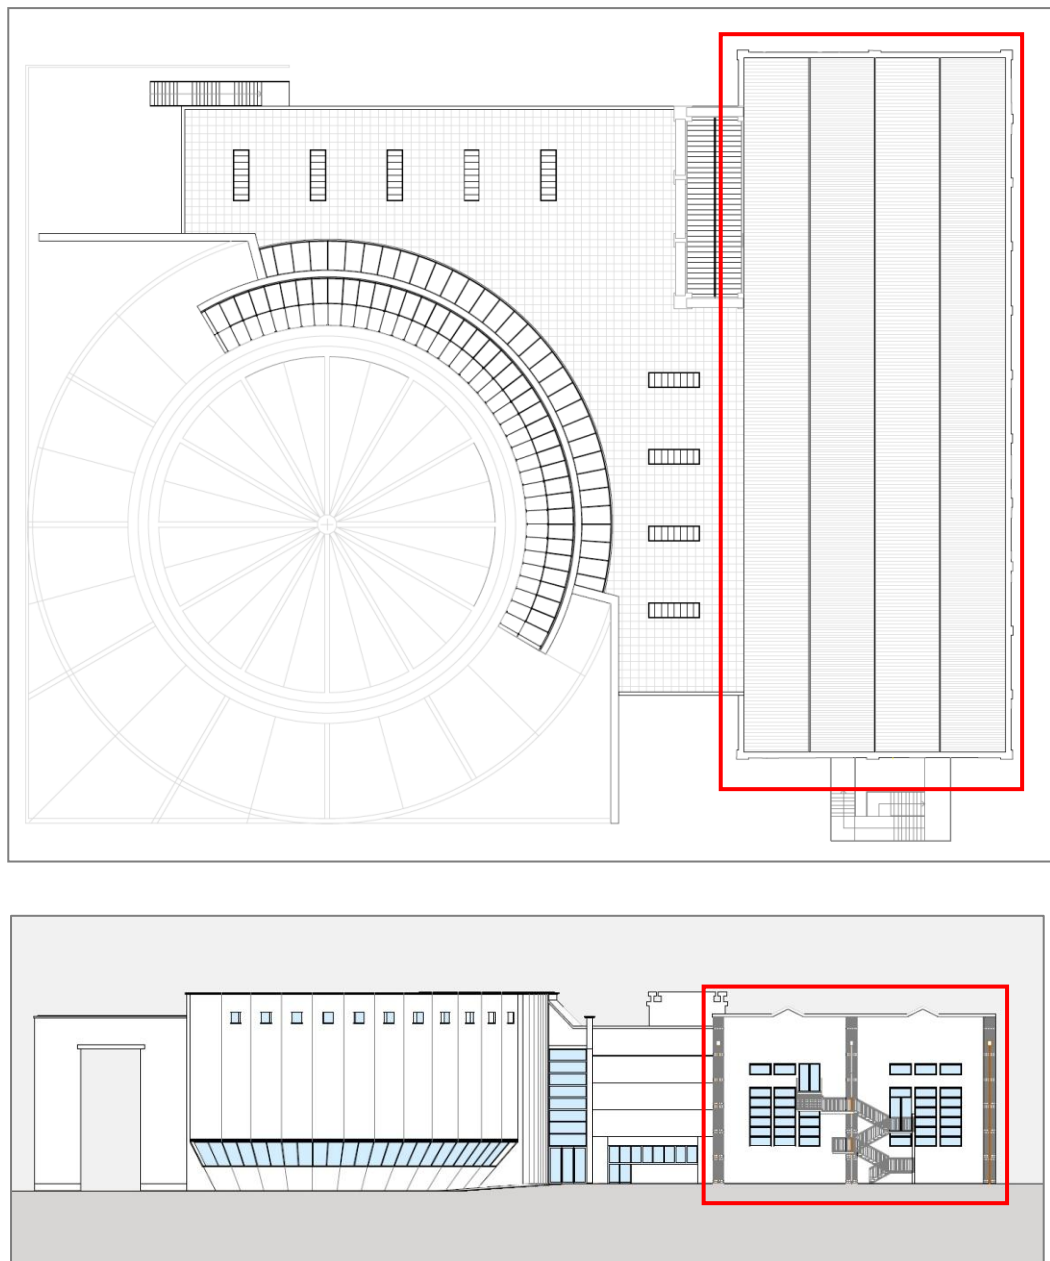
MAGA: pianta copertura e prospetto Nord-Ovest
